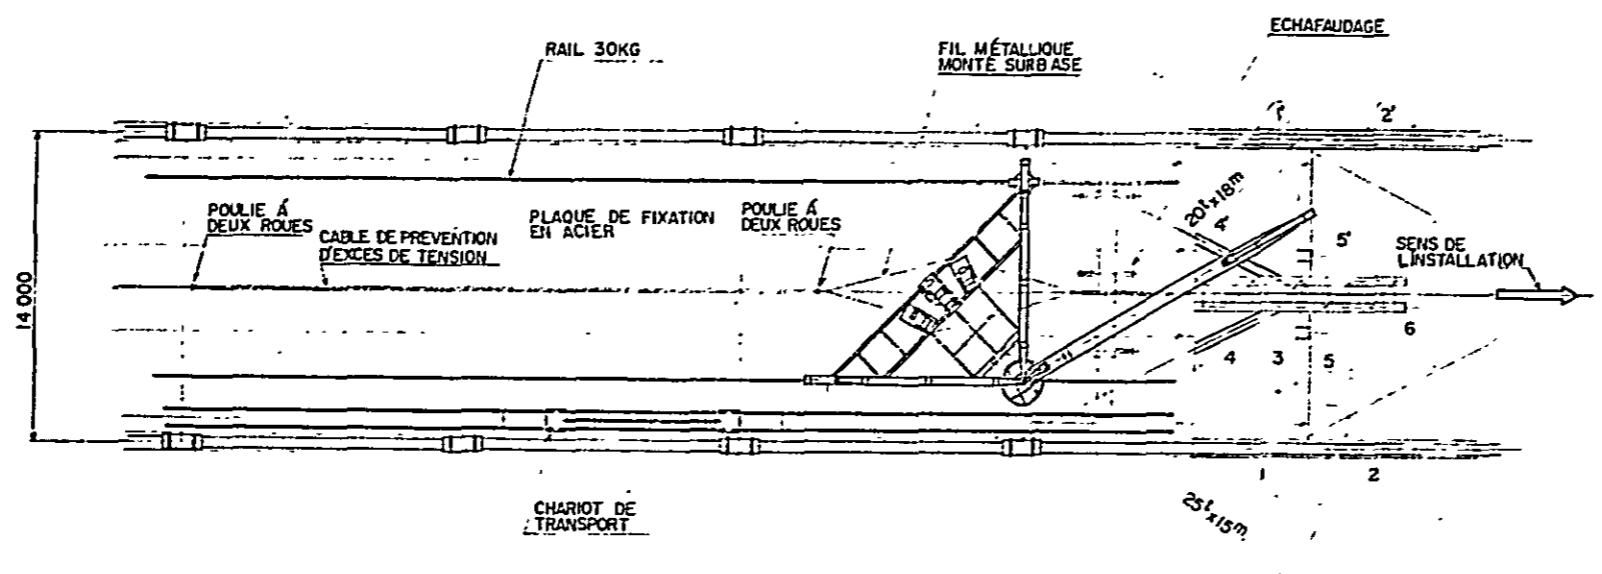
PLAN D'INSTALLATION DE LA FERME DE RENFORCEMENT
